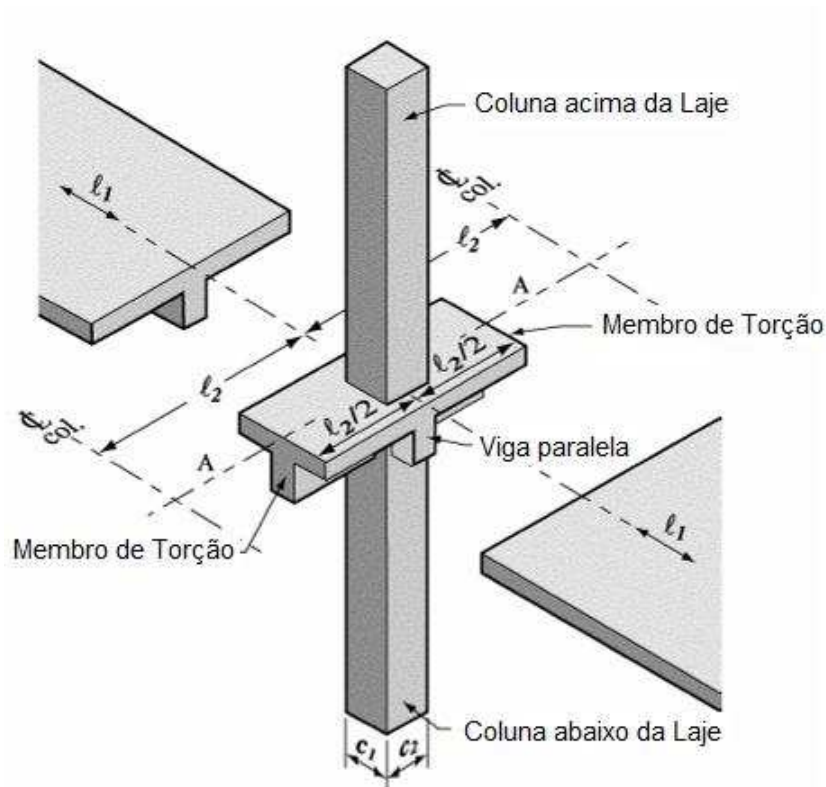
Pilar equivalente (pilar mais elementos de torção), ACI 318 (2005).
